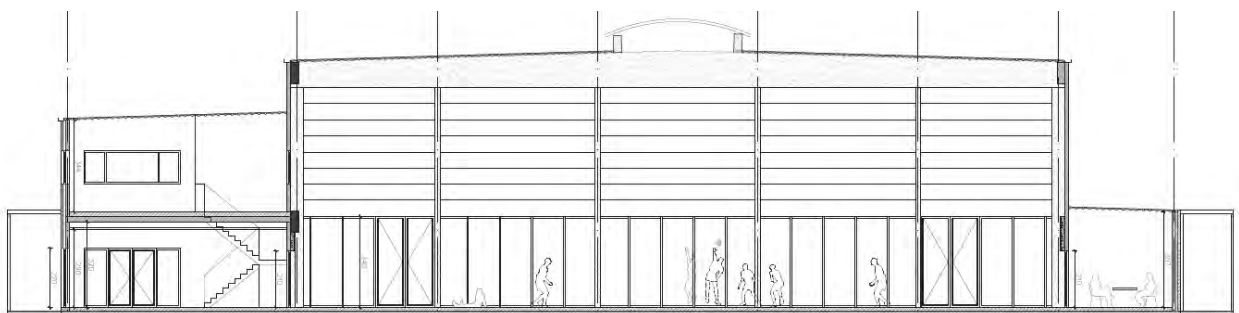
Coupe transversale du Hall sportif en situation projetée (51N4E, 2018)
